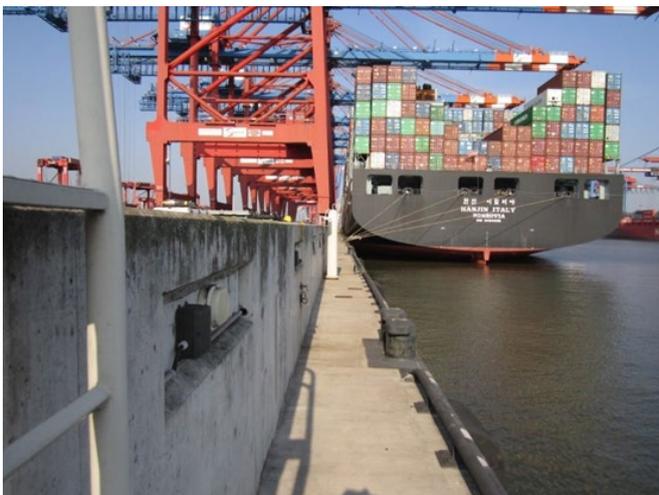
ハンブルグ港での防潮壁設置状況事例
